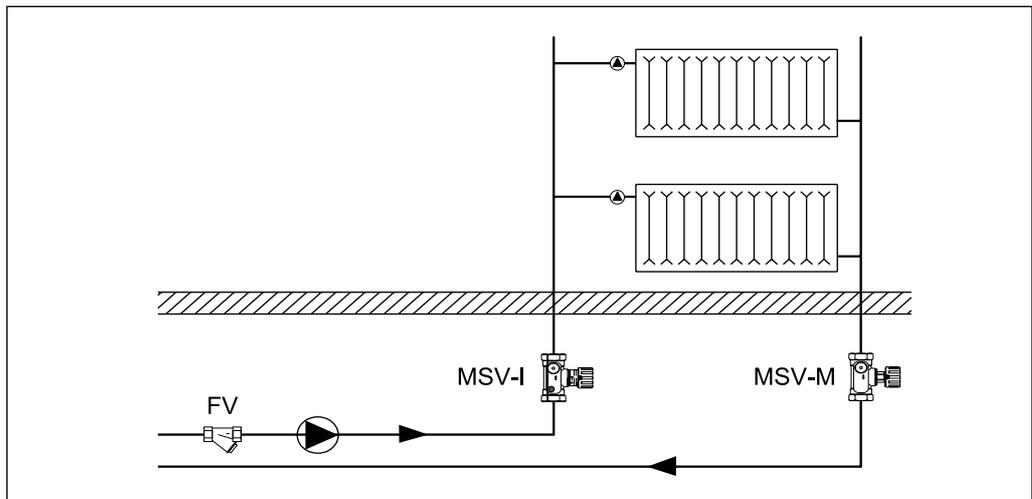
Установка MSV-I и MSV-M на стояке системы отопления
